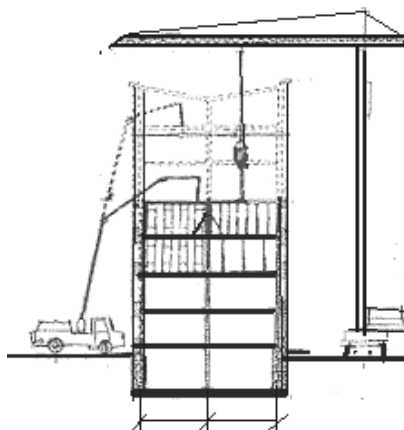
Подача бетонной смеси автобетононасосом для устройства монолитных перекрытий
